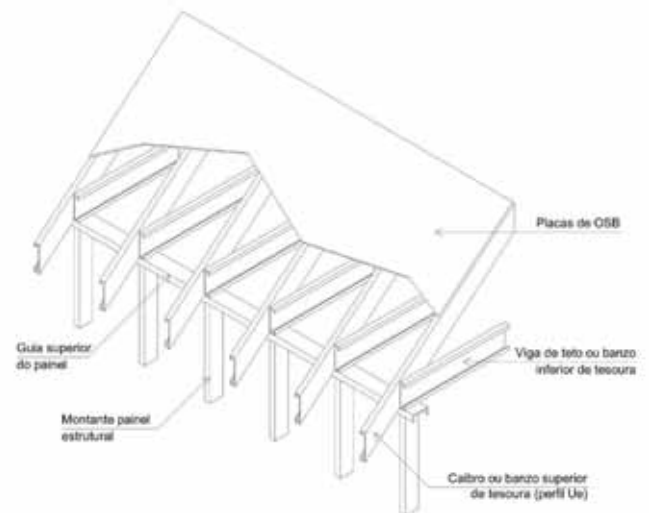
Caibros e vigas alinhados com montantes de painel estrutural.
